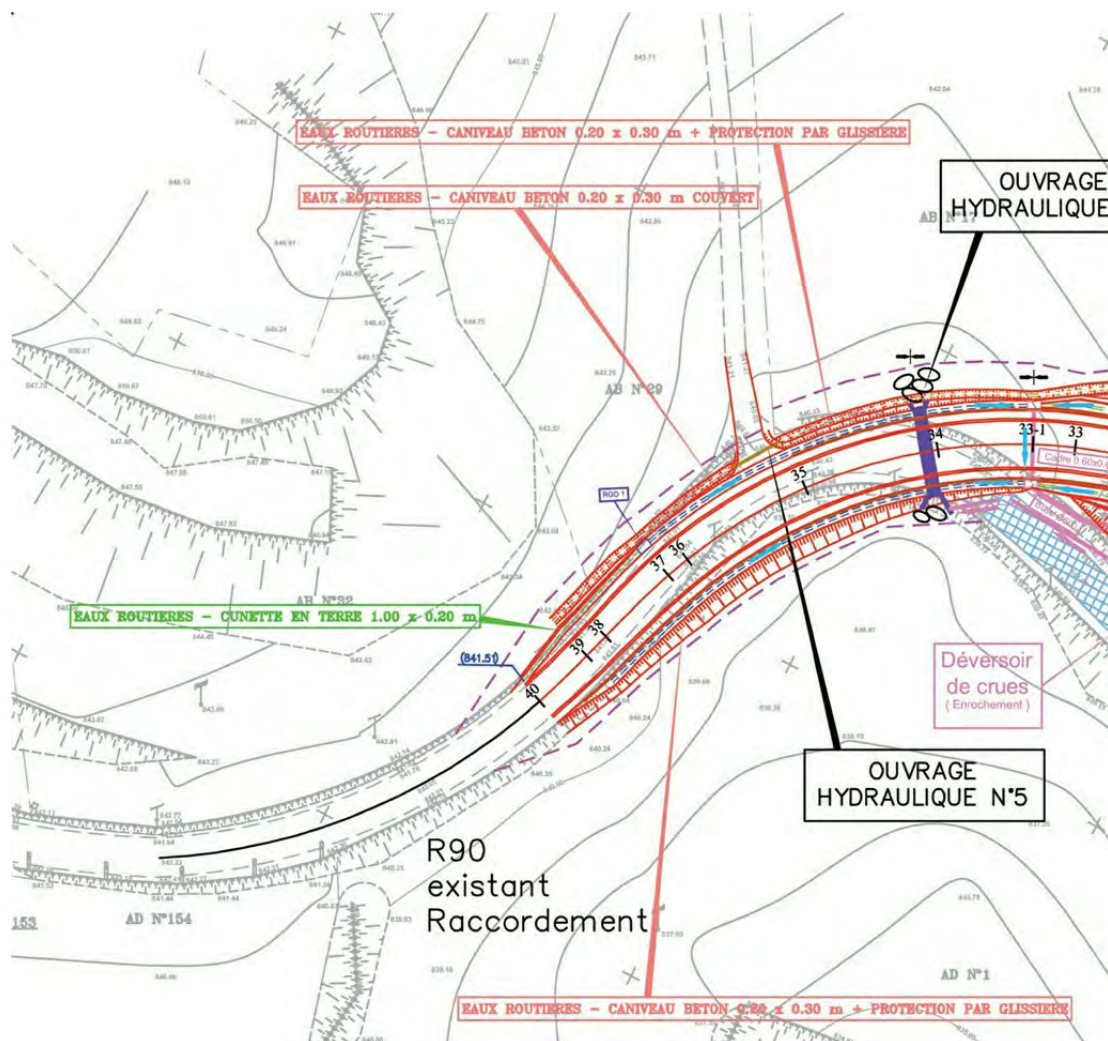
Extrait d'un plan d'assainissement. (Voir p.20-21)
